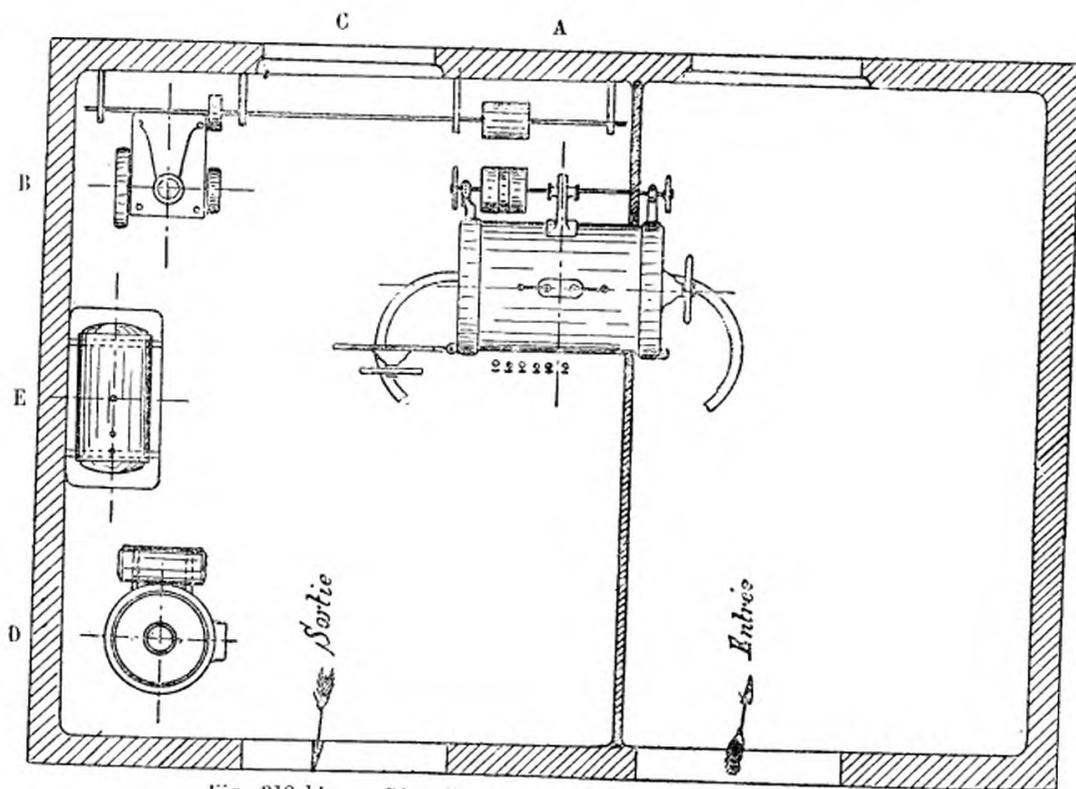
bis. — Plan d'installation de la laveuse-désinfecteuse Dehaitre.
